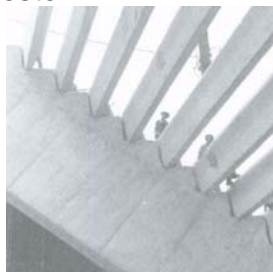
Montaje de traveses "I" de sección variable para las aulas del sistema CAFCE
